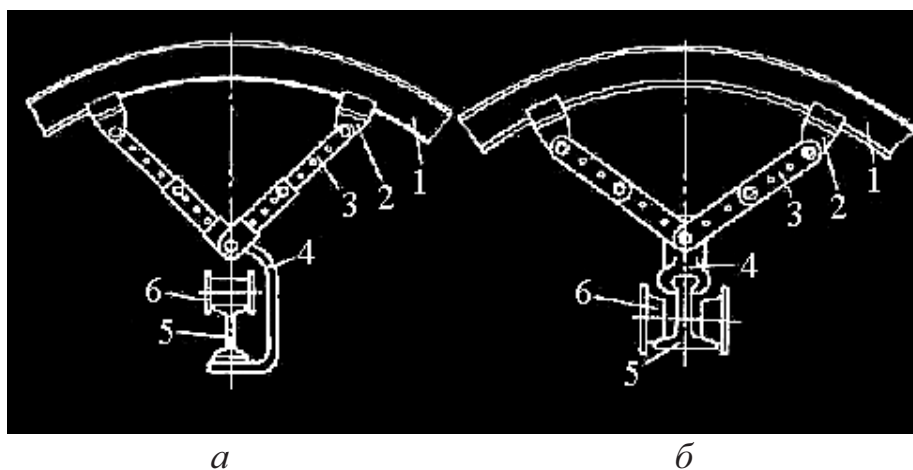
Схема подвески монорельса в выработках, закрепленных металлической крепью: а – система «Бекорит»: 1 – арочная крепь; 2 – зажимное устройство; 3 – растяжки; 4 – кронштейн; 5 – двутавровая балка; 6 – каретка.
